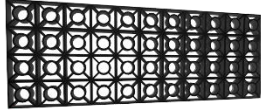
16 Rancangan Detail Arsitektur Khusus Pada Bangunan
